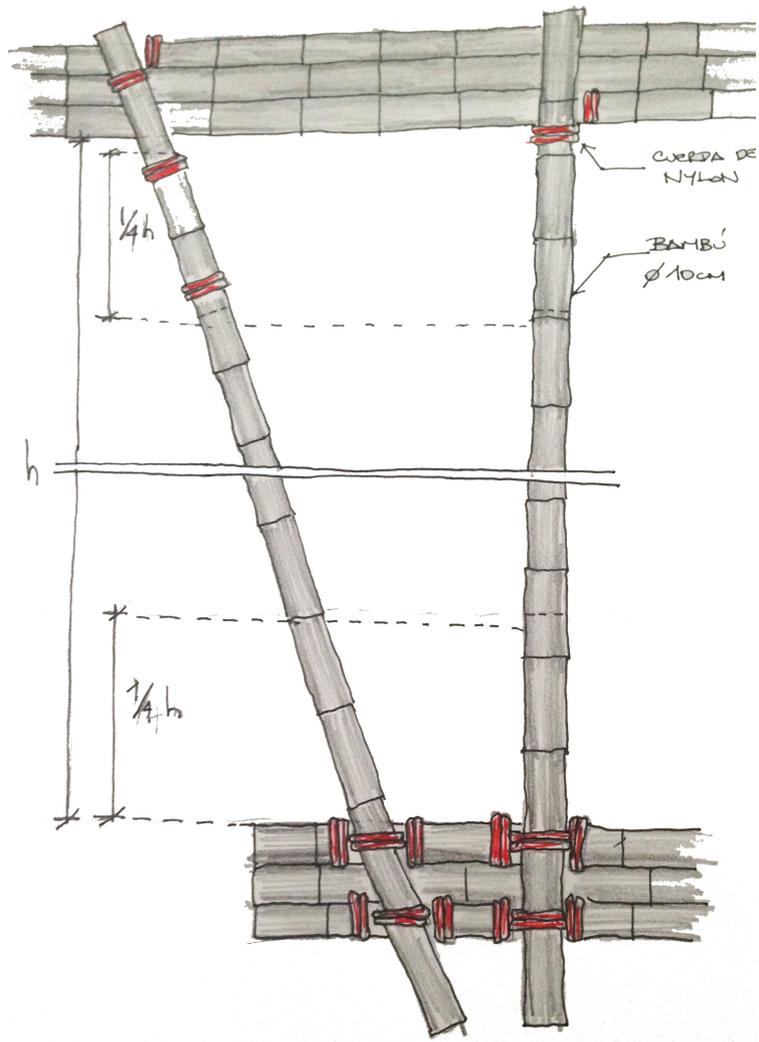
Boceto en el cual se analiza el armado de las vigas compuestas. Detalle de columna compuesta que conforma el perímetro. (Fuente: elaboración propia).
